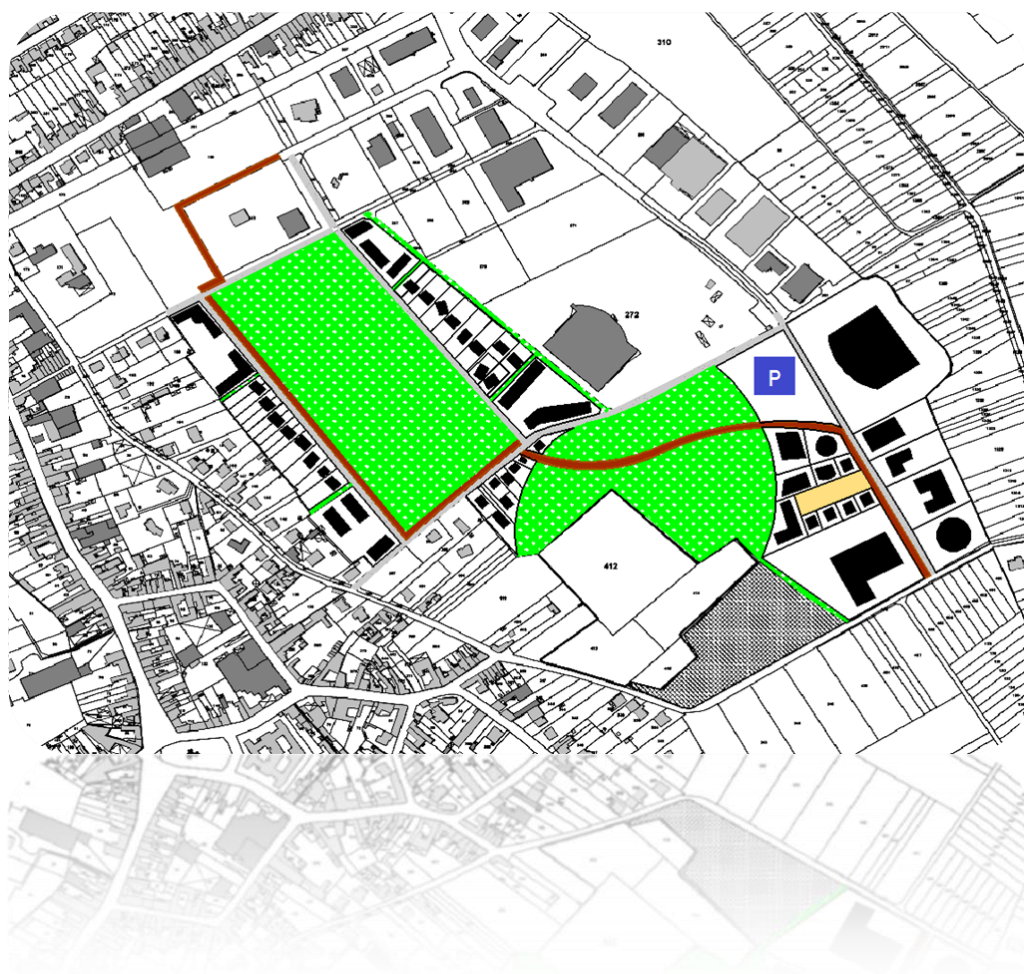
PLAN MASSE DE LA ZONE AMENAGEE
